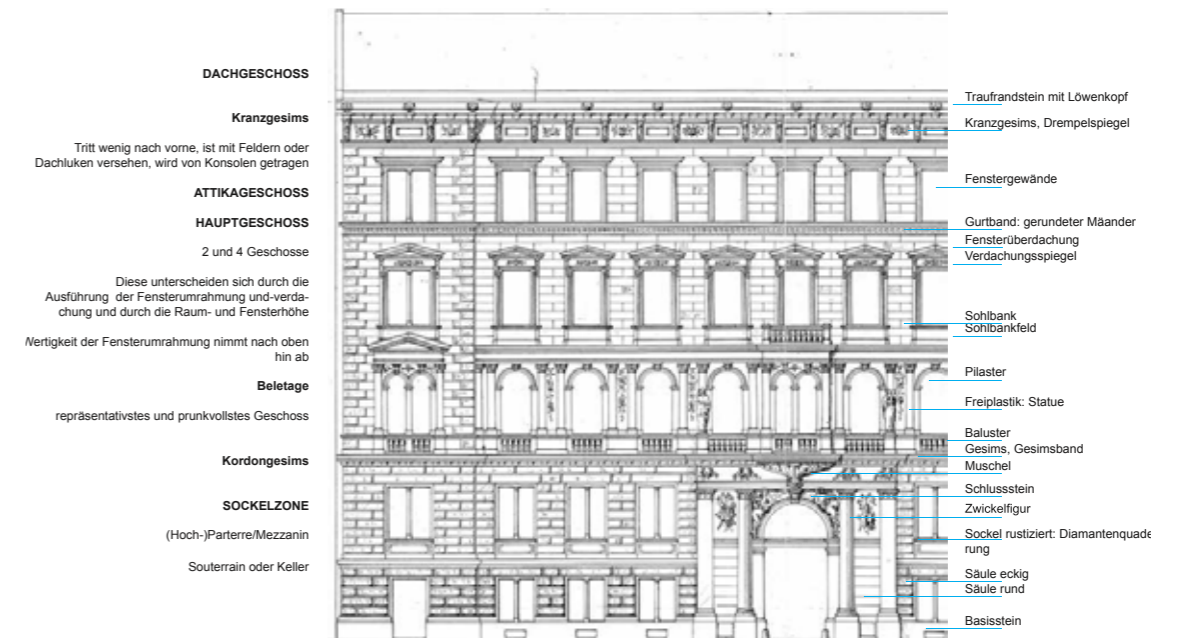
Gebäudefassade Hochgründerzeit, Wien
